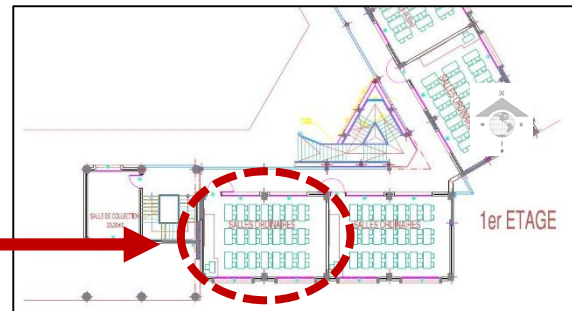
l'emplacement des salles par rapport aux plans.
